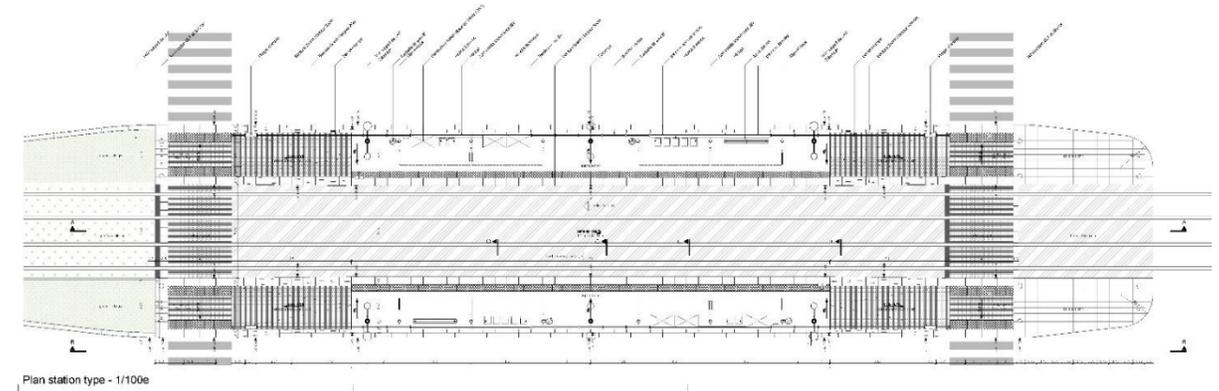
Plan d'une station. Source : PRO du prolongement du T7, mai 2021
